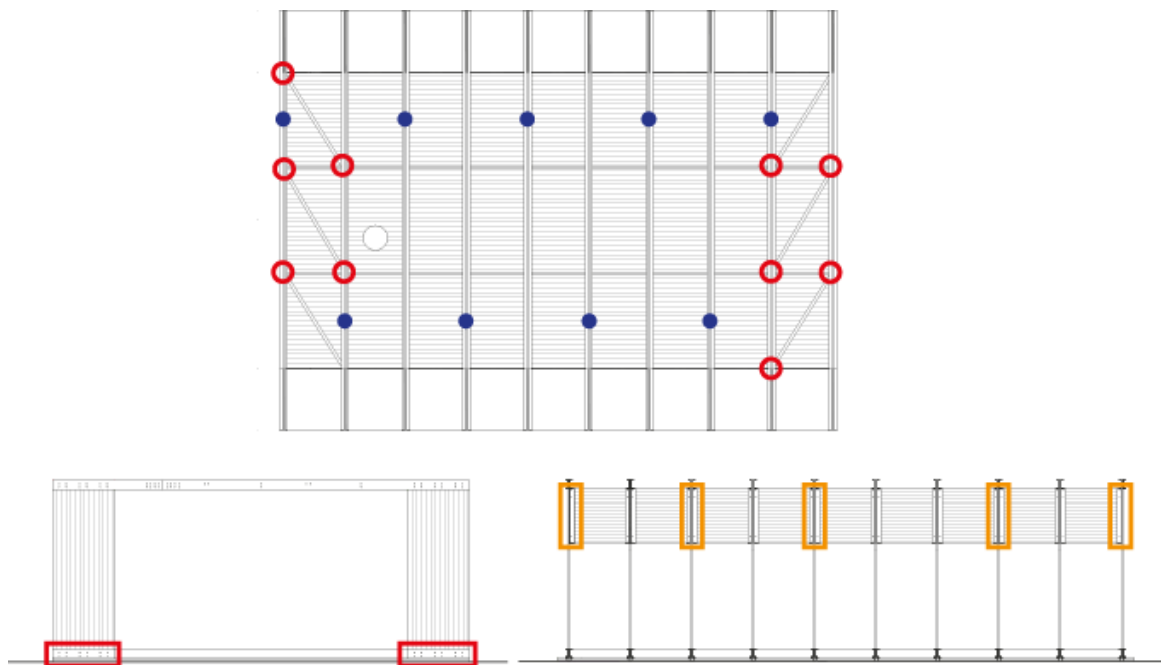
Glass House a) planimetria delle coperture con i collegamenti B e C. Prospetto con il nodo A. Prospetto con nodi E e D.
